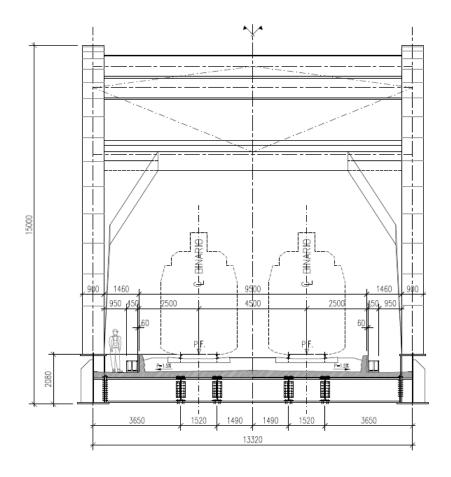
Sezione trasversale tipo dell'impalcato metallico.
